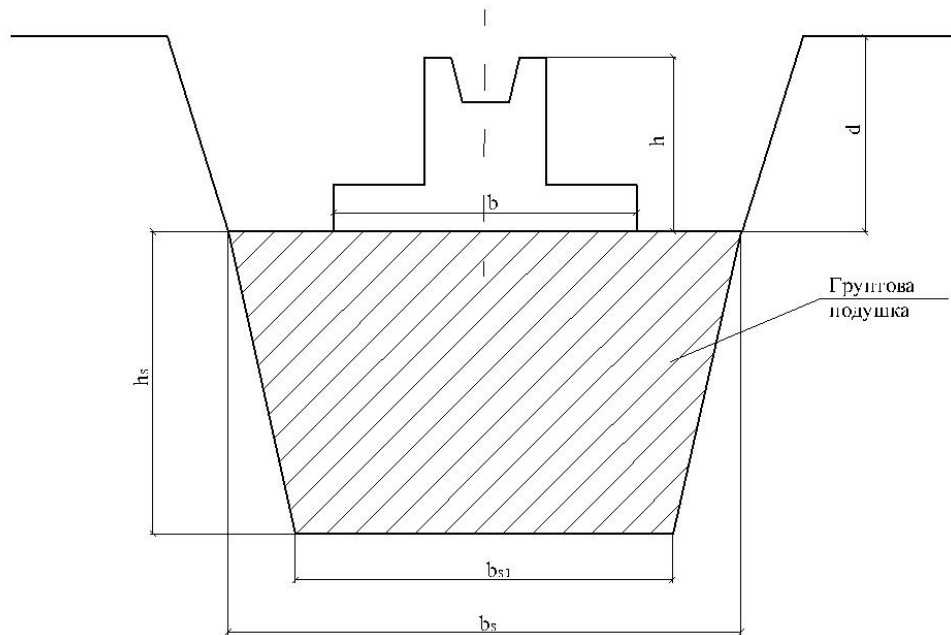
Фундамент на ґрунтовій подушці
